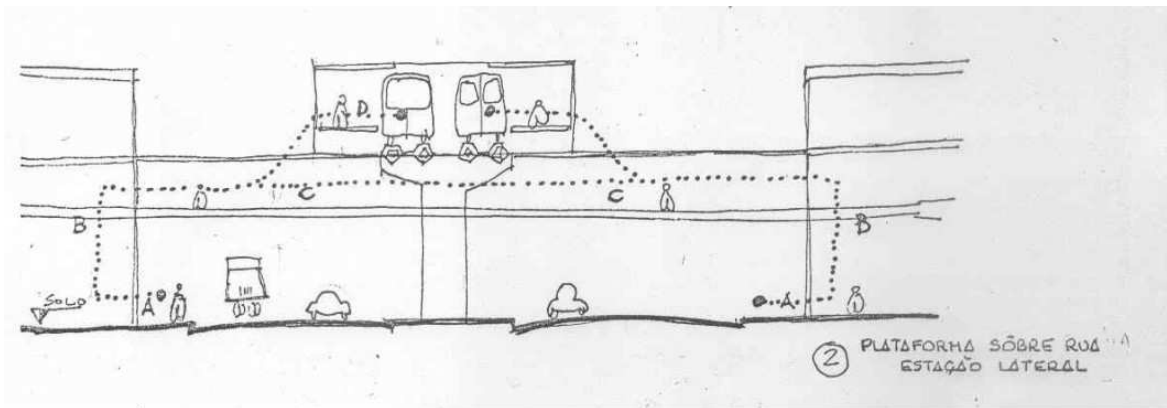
Plano Preliminar do Metrô - estação lateral, plataforma sobre rua
